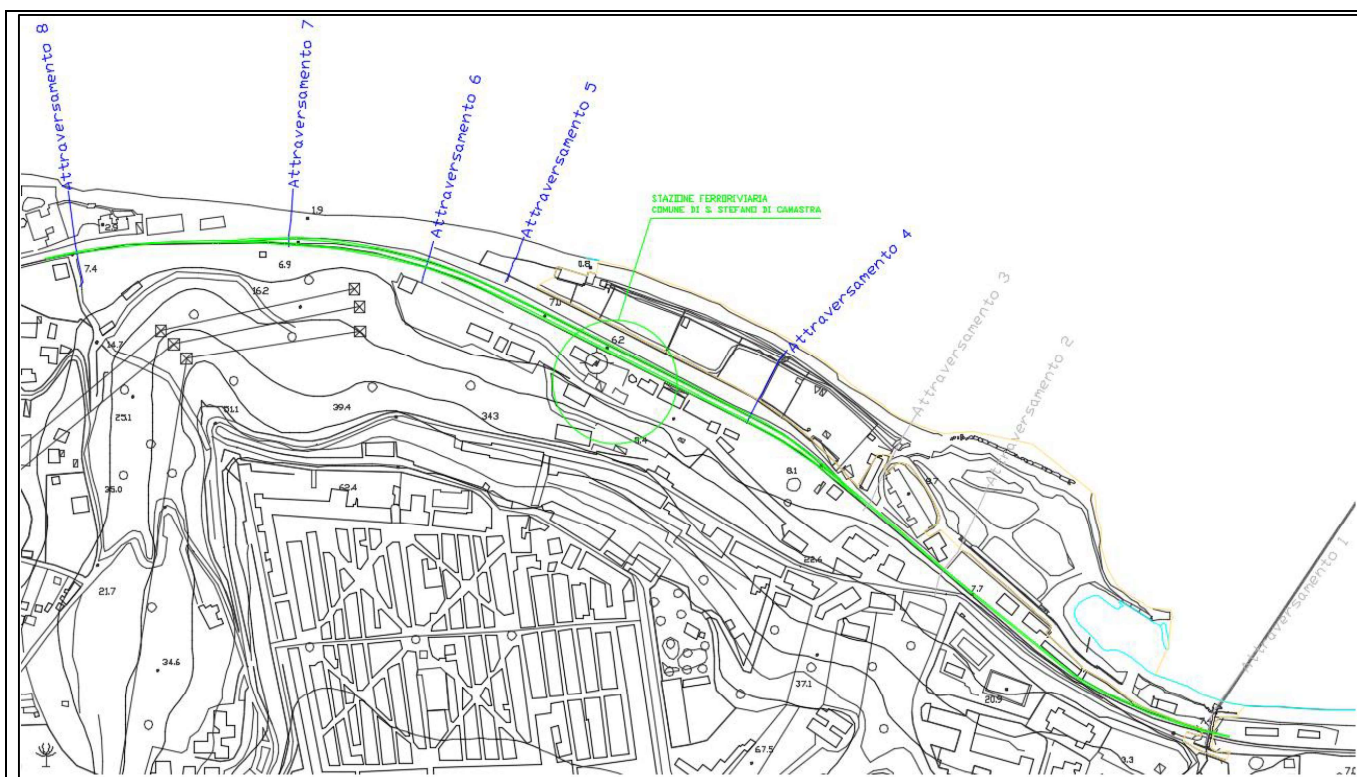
Schema planimetrico degli attraversamenti idraulici da n° 4 a n° 8.
